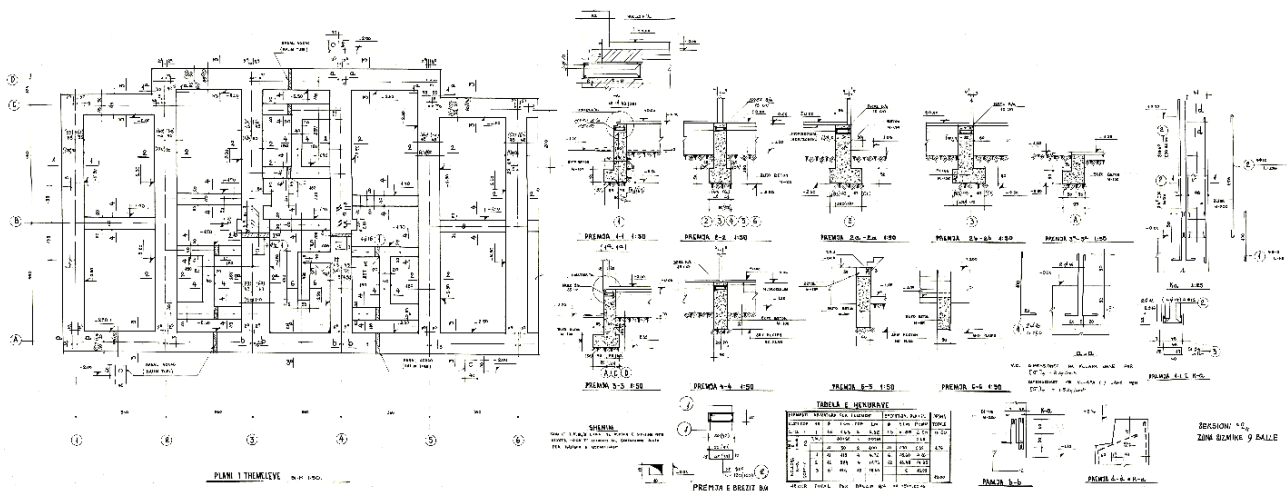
Pianta e dettagli delle fondazioni del Modulo 2, zona sismica con magnitudo 9, I.S.P. n. 1, 1981 [AQTN]
